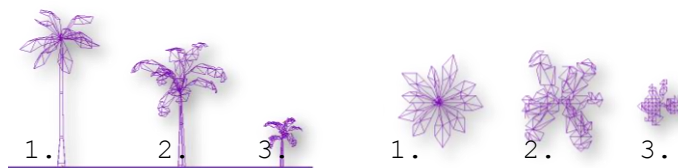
Árboles Tratamiento Tipo 3. Alzado y Planta
